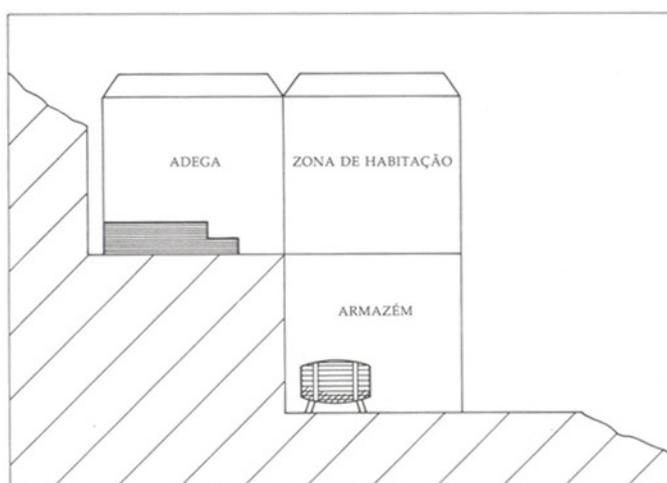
Corte Transversal de uma casa de quinta (retirado de [2])
